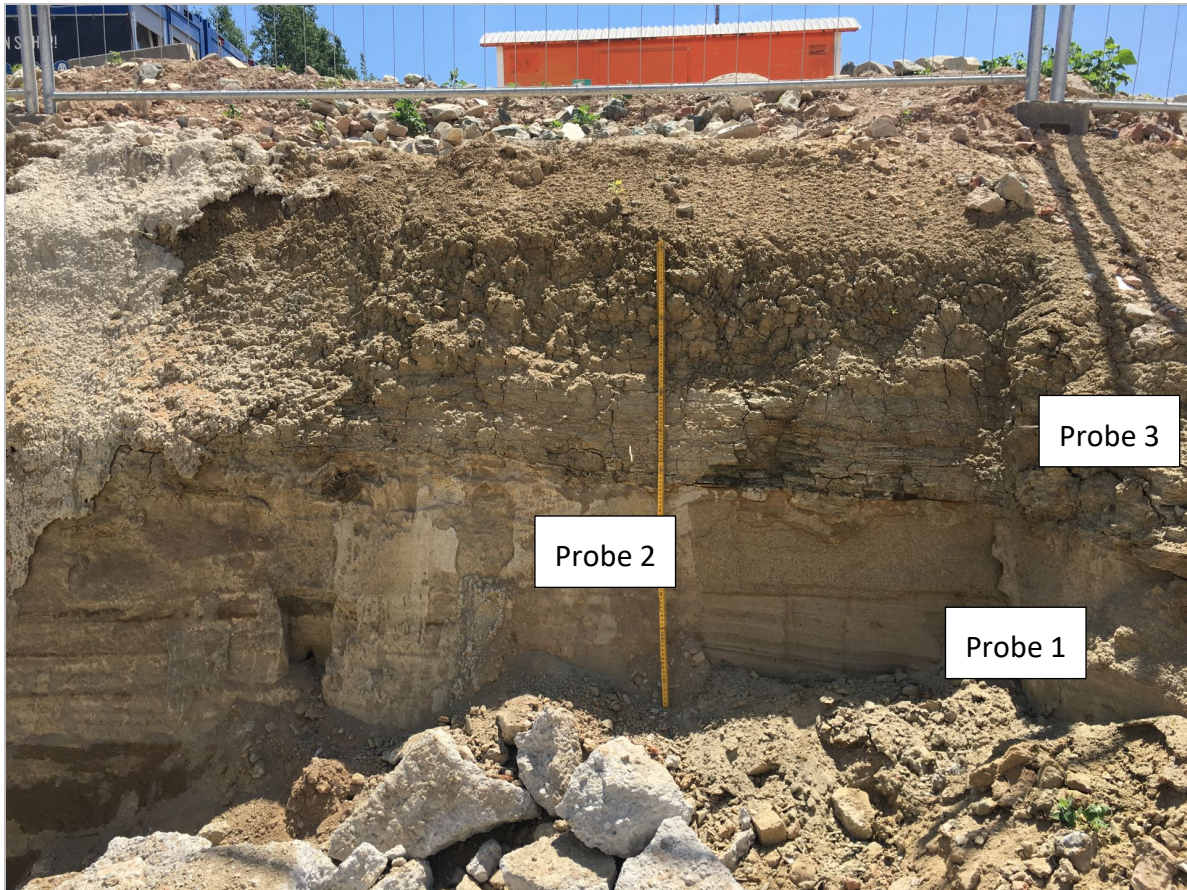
Baugrube für eine Lagerhalle westlich von Pinkafeld: Hanganriss an der Südseite des Baustellengeländes mit Probenahmepunkten (Foto: M. Peresson).
